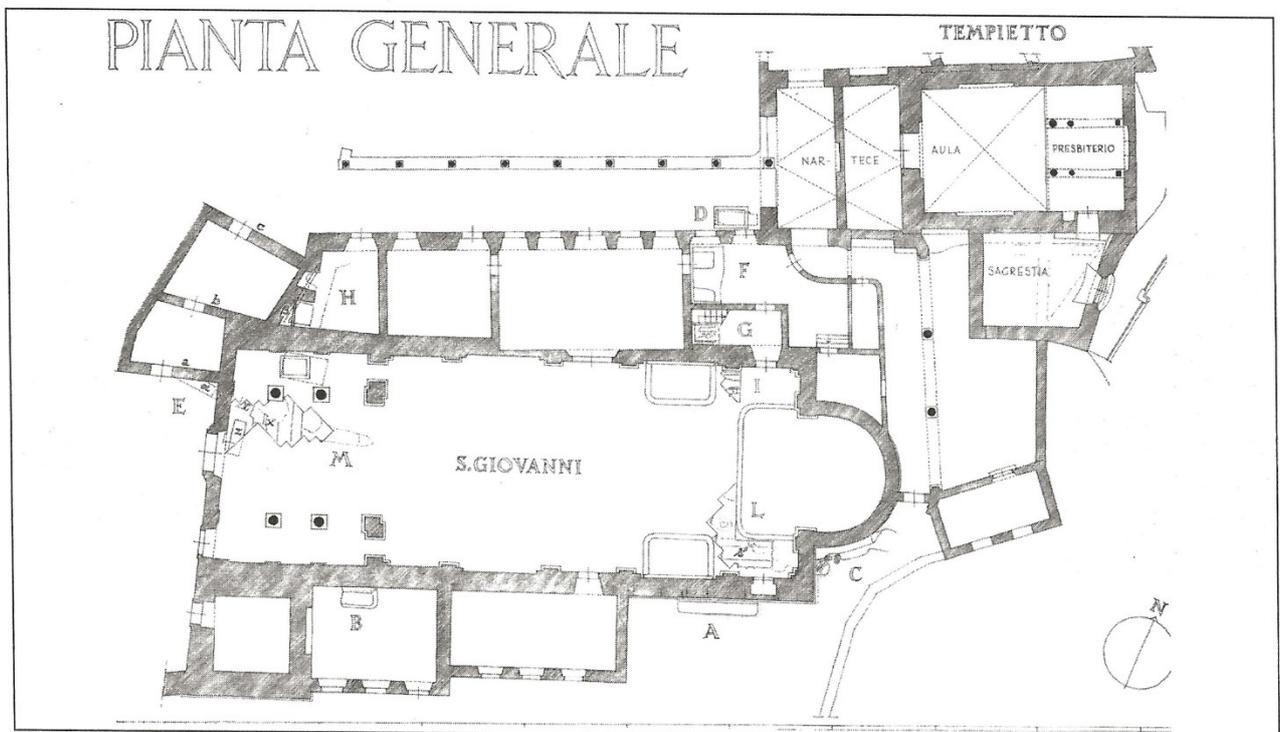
Pianta attuale della chiesa di San Giovanni e del Tempietto
